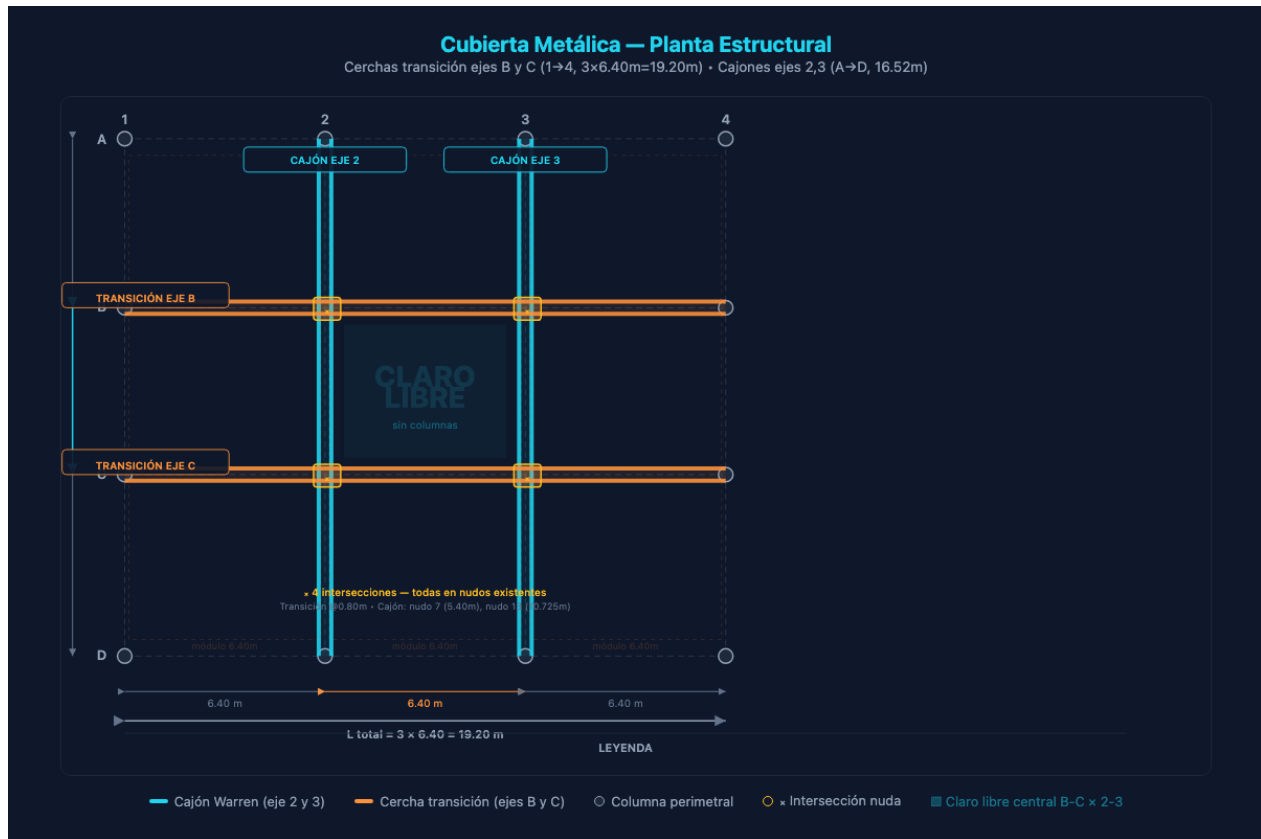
Planta estructural de la cubierta metálica. Ejes 1–4 (19.20 m) y A–D (16.52 m). Cajones Warren en ejes 2 y 3 (cian). Cerchas de transición en ejes B y C (naranja). Las intersecciones × transfieren las reacciones como cargas puntuales.
